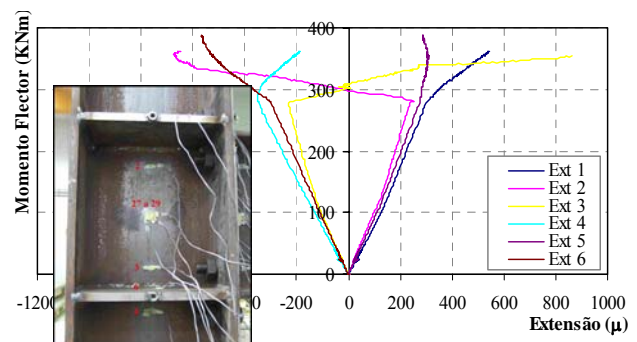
Extensões na alma e nos reforços transversais da alma do pilar.
